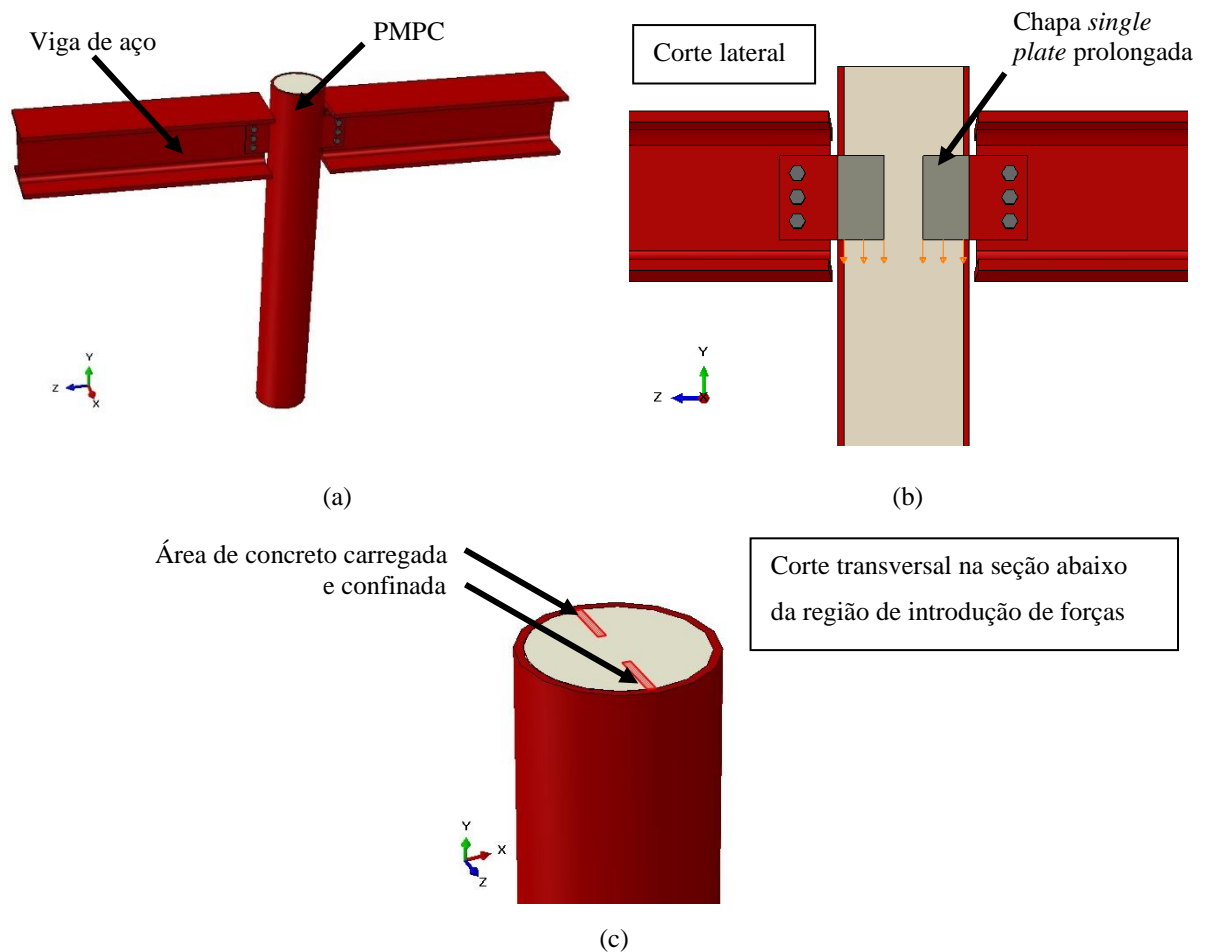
Introdução de forças em PMPC através do prolongamento de chapas *single plate*: (a) ilustração de ligações entre vigas de aço e PMPC; (b) corte lateral em PMPC e introdução de forças; (c) corte transversal abaixo das chapas *single plate* prolongadas e ilustração da área de concreto carregada e confinada.
